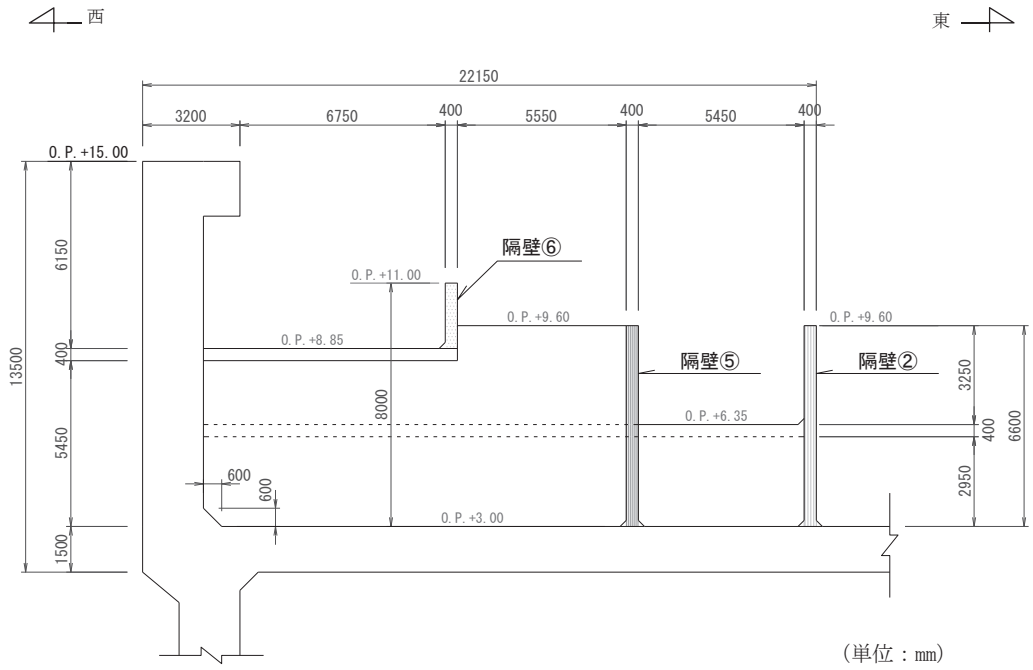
(6) 補機ポンプエリア断面図 (⑥—⑥断面)
